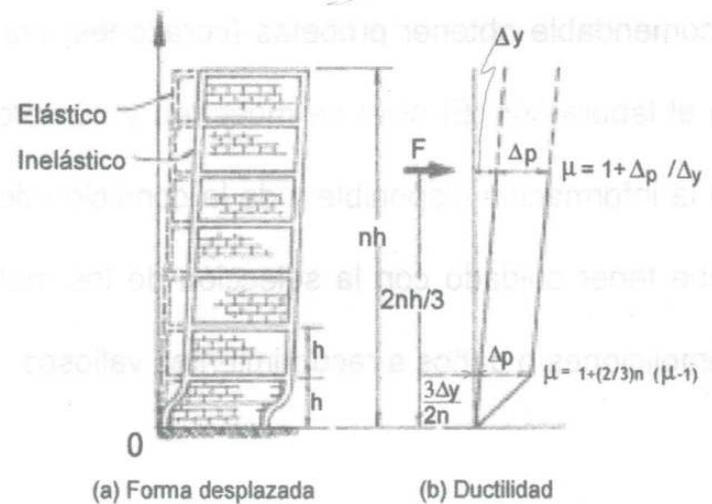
Fenómeno de piso suave producido por desplazamiento inelásticos en planta baja (Paulay y Priestley, 1992)
